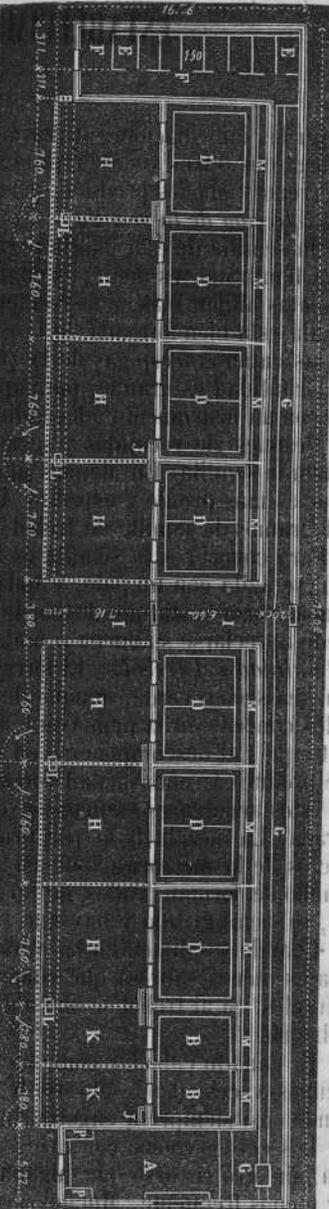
Planta del establo de la granja imperial Fouilleuse.
